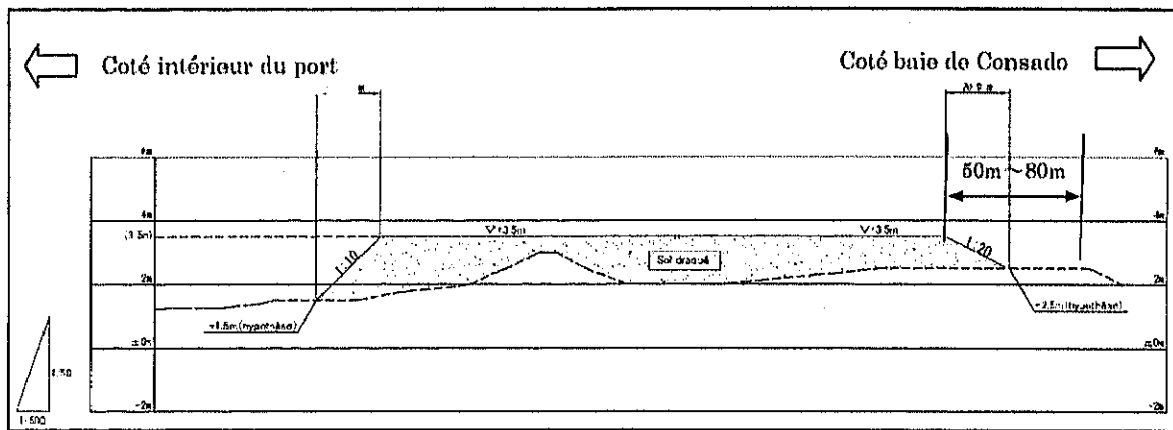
(12) Plan de section transversale du nivellement à l'aide des déblais de dragage
